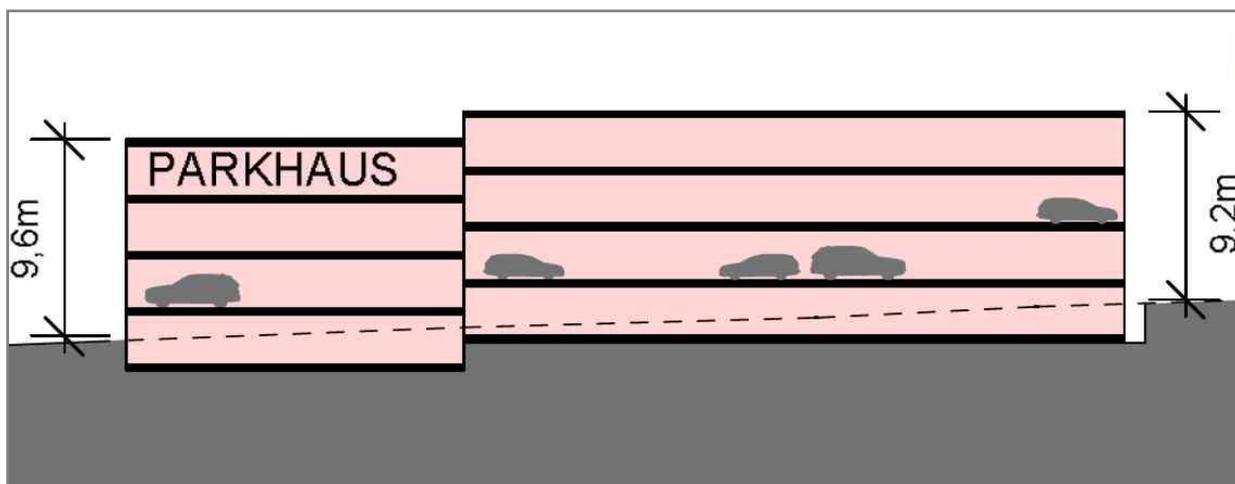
Planungsvariante 1b - Schnitt Ansicht Südwest /14/.
